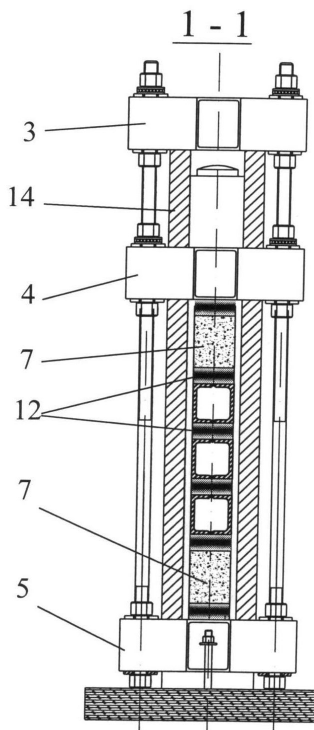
Разрез 1-1 на рис. 1 [3], где: 3 – верхний ригель; 4 – средний ригель; 5 – нижний ригель; 7 – железобетонная балка (образец); 12 – центрирующая опора; 14 – страховочная рейка.
